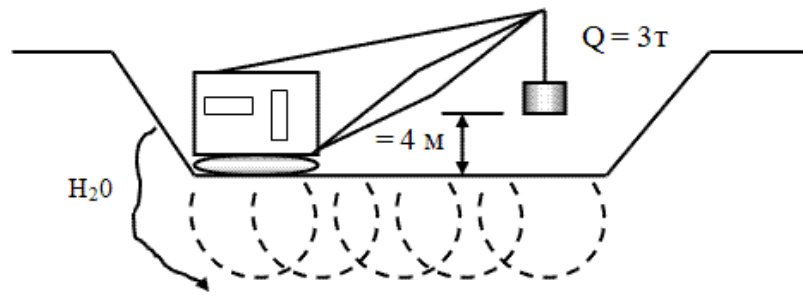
Схема усунення просідання лесового ґрунту методом поверхневого ущільнення
